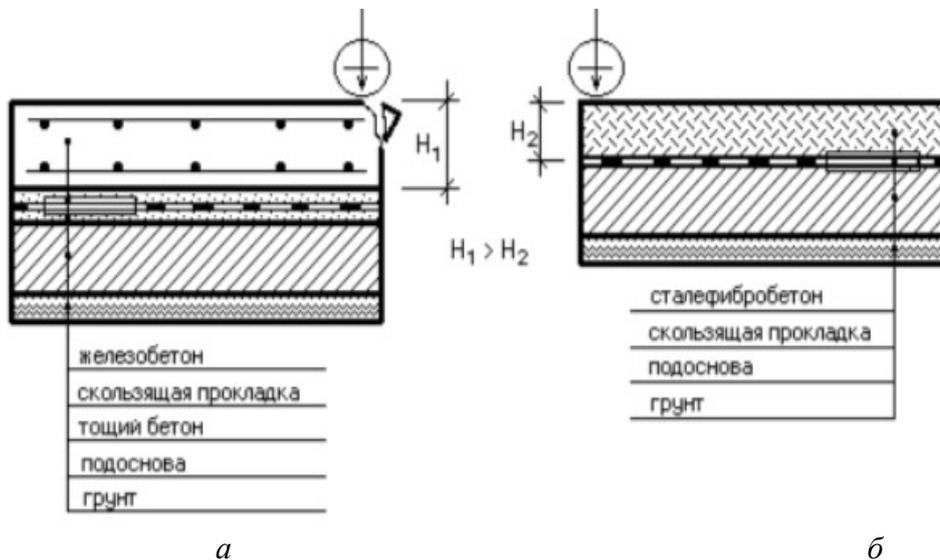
Конструкции дорожного покрытия: *а* – классический железобетон; *б* – сталефибробетон
